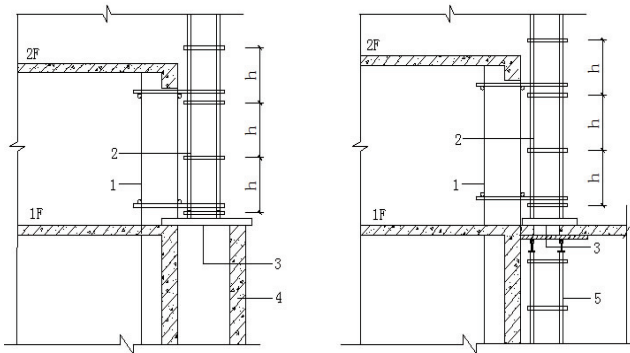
脚手架坐落采光井或后浇带结构上示意图
